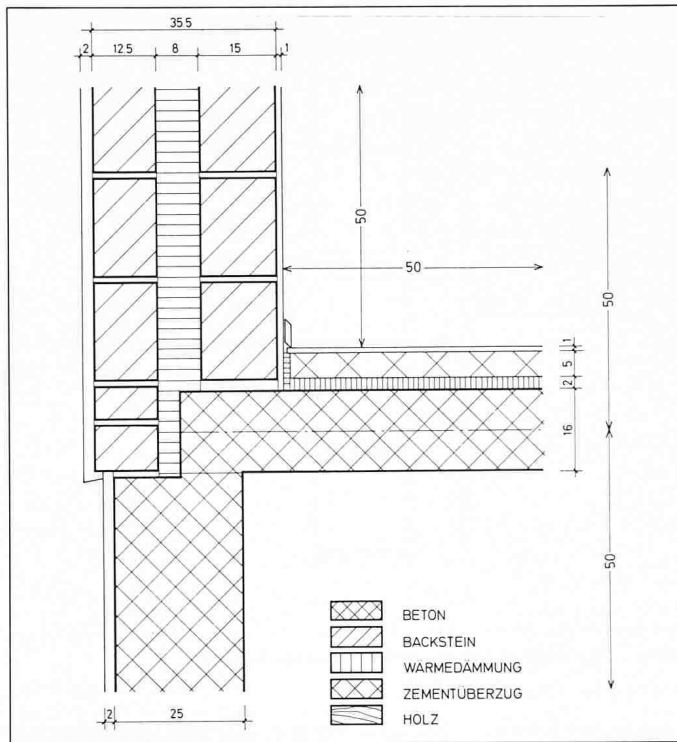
Zwei-Schalenmauerwerk, Detail Sockel
